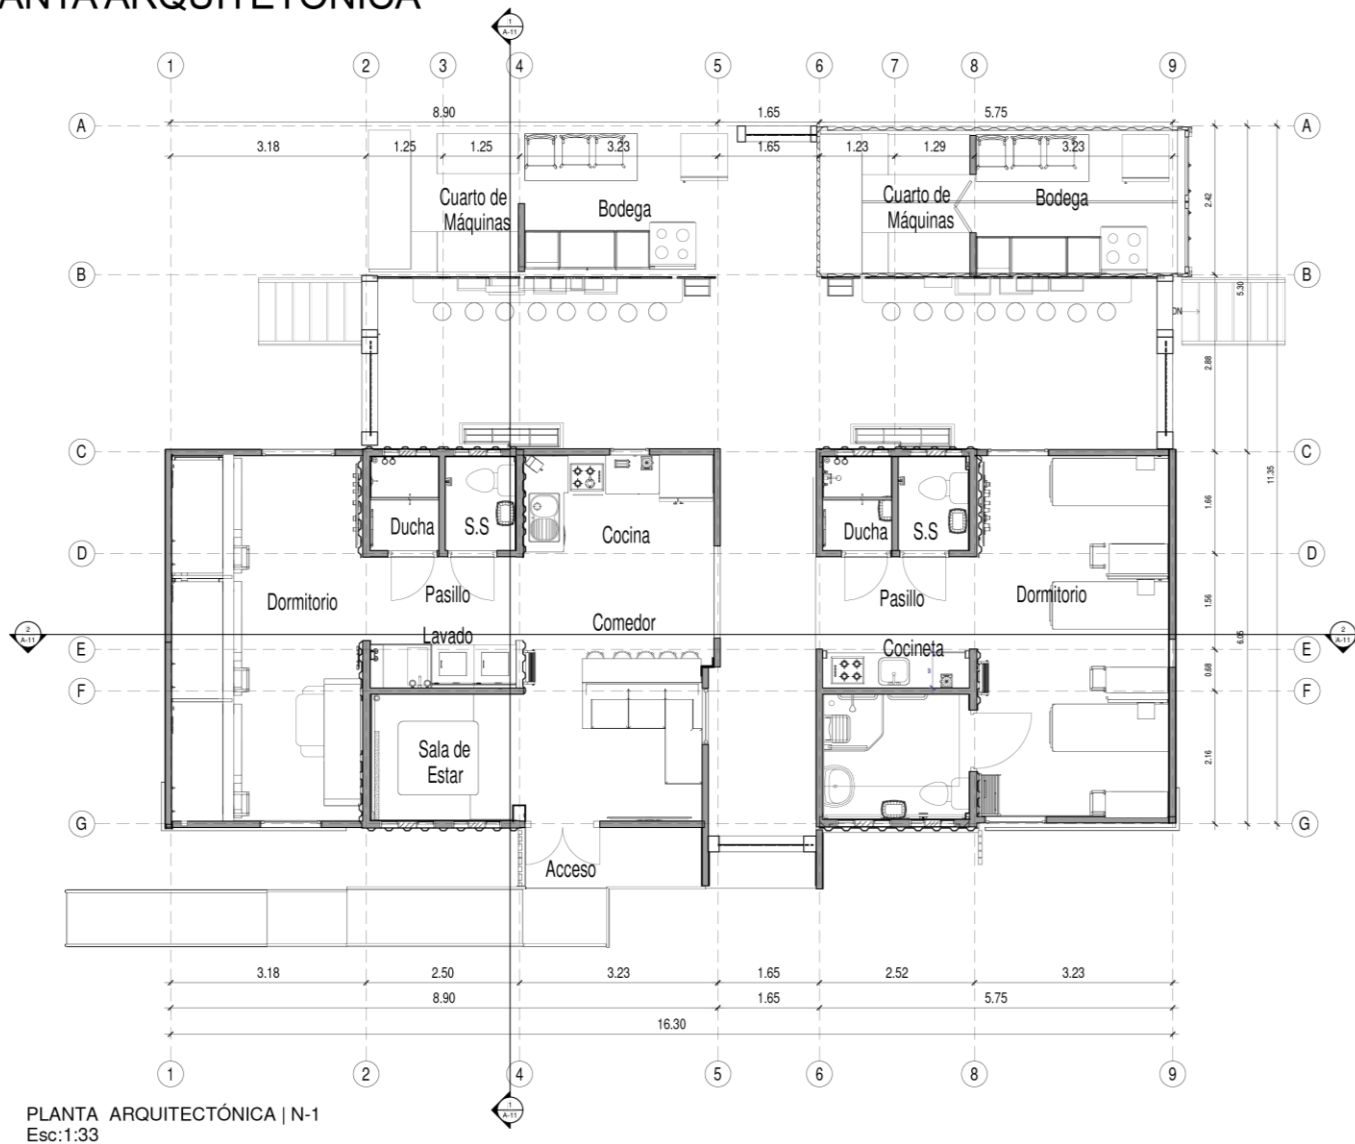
Planta Arquitectónica. Elaboración propia.
